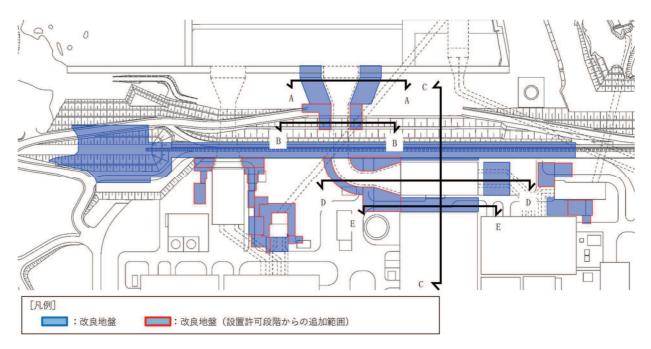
地盤改良体の配置図(取水口,取水路,海水ポンプ室,
